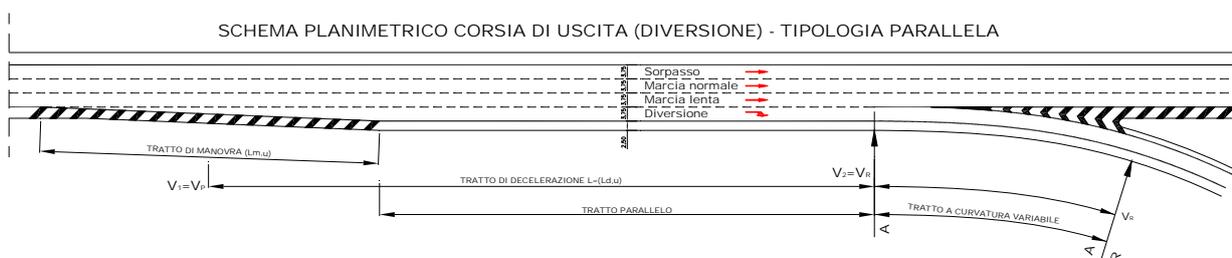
Schema planimetrico corsia di diversione - tipologia parallela
